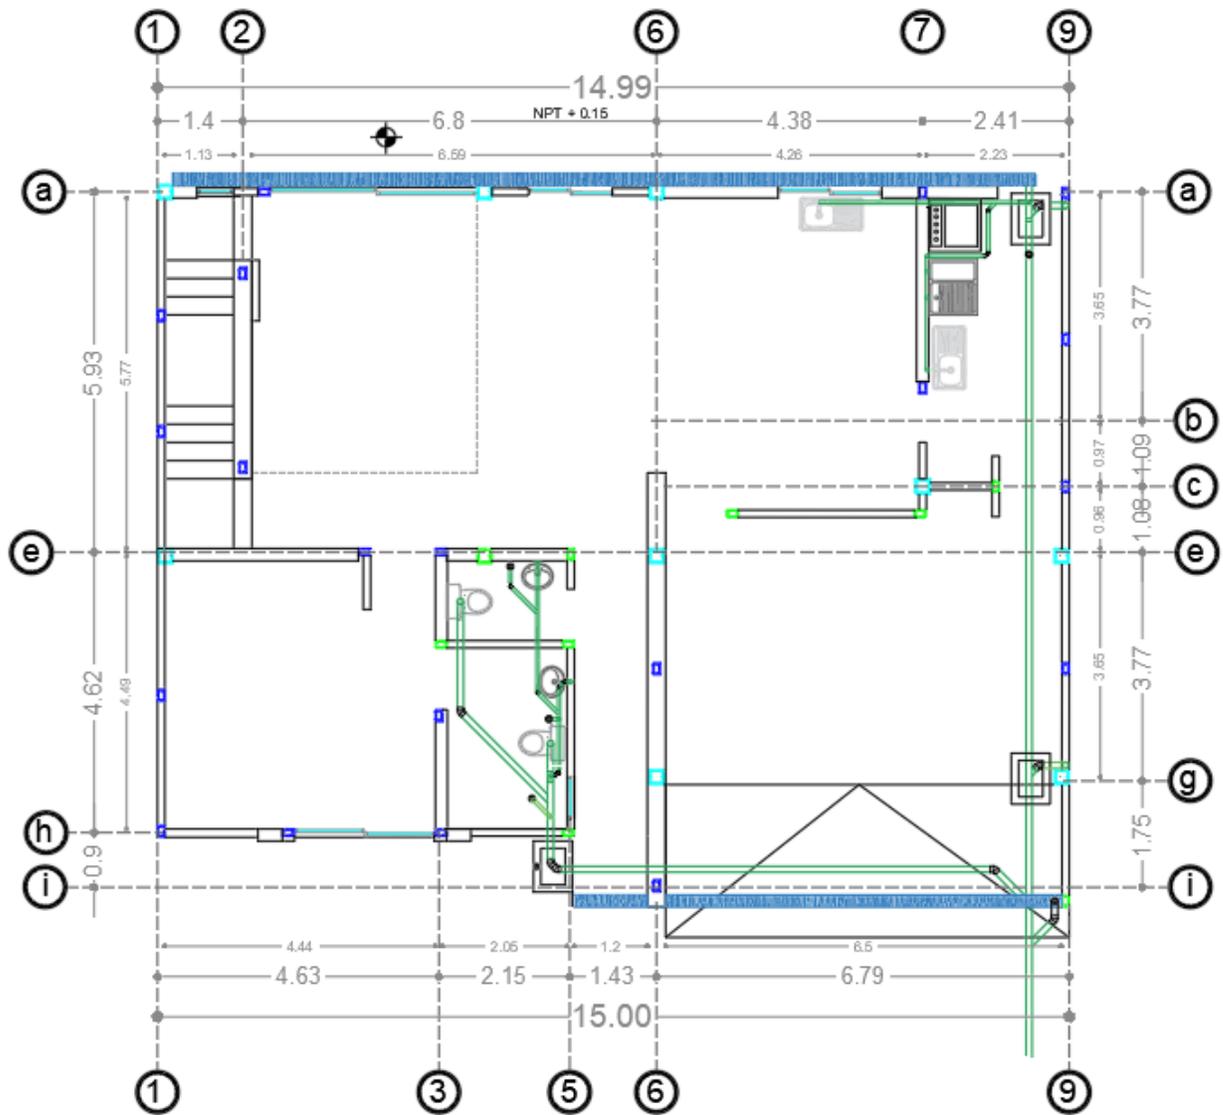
Plano sanitario planta baja (Muciño, 2022)
